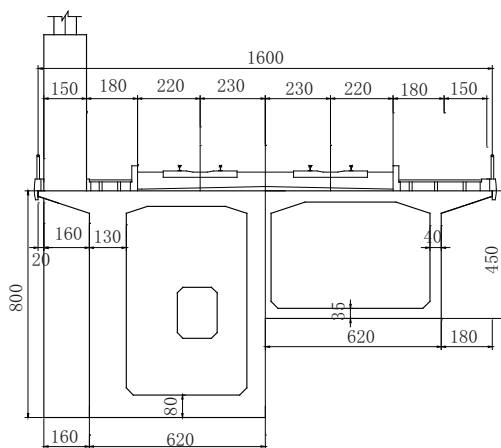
主梁中支点、跨中横断面布置图(单位:cm)
